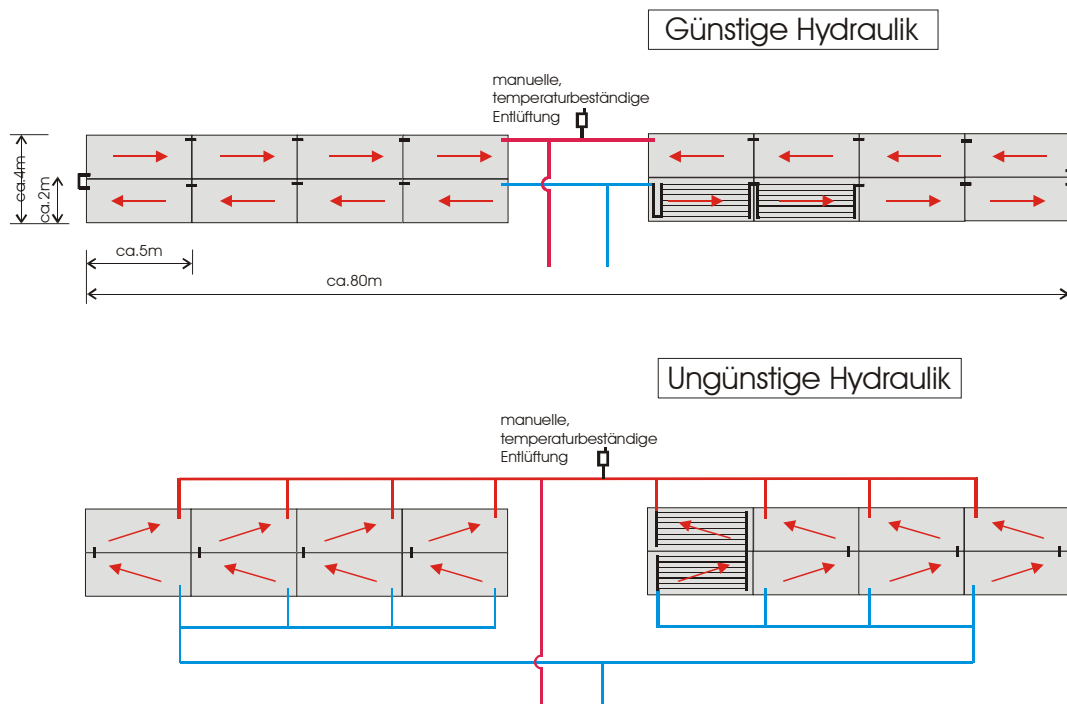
Zwei beispielhafte Kollektorverschaltungen einer dachintegrierten Kollektorfläche mit 160m² Bruttokollektorfläche. Die obere Hydraulik benötigt kaum externe Rohrleitungen, die untere Hydraulik etwa um 90 m Verrohrung mehr.
